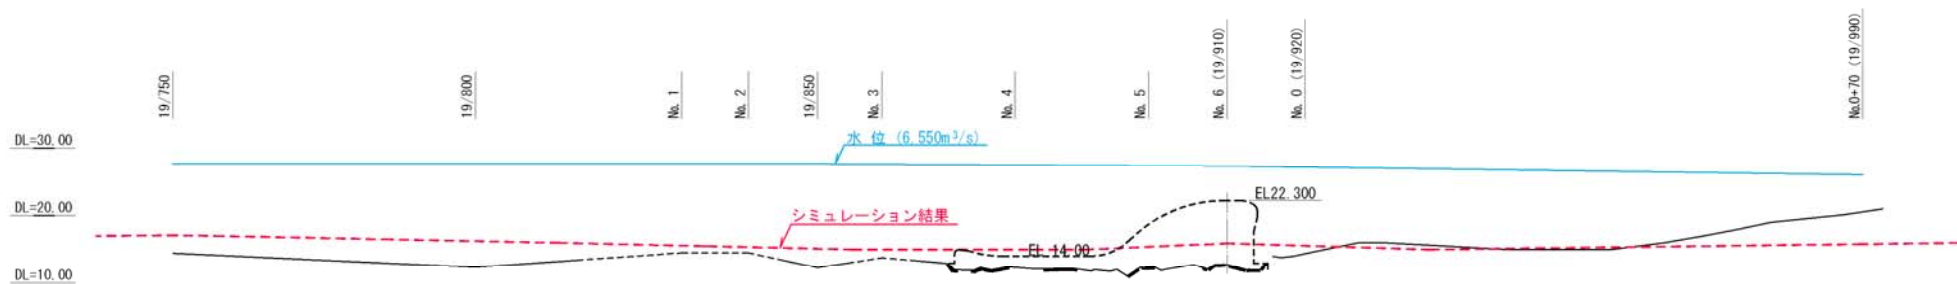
覆土計画図(覆土量 1.5万 m³)
